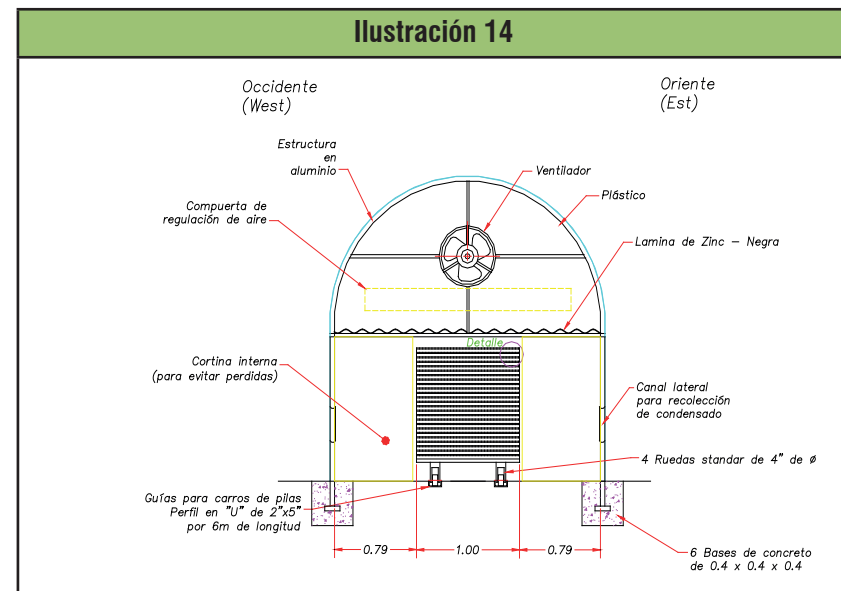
Conjunto secador solar tipo invernadero ventilación longitudinal, vista frontal.
